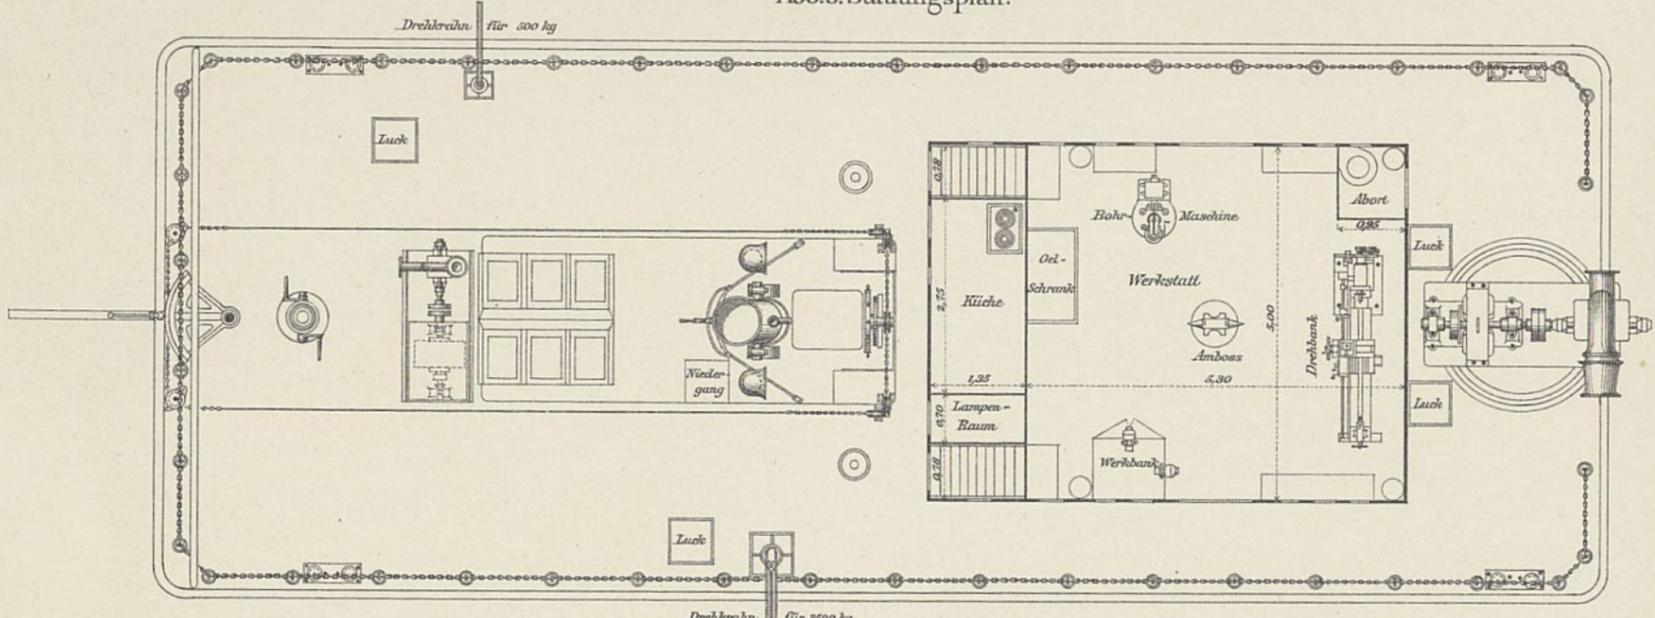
Deckplan und Grundriss der Werkstatt.
